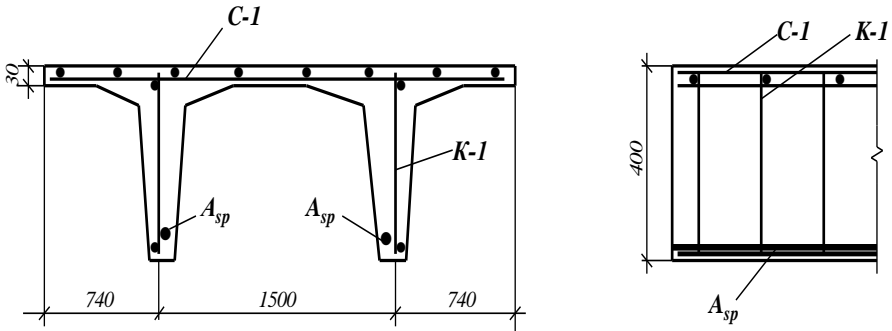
Конструювання плит покриття типу "2Т"
